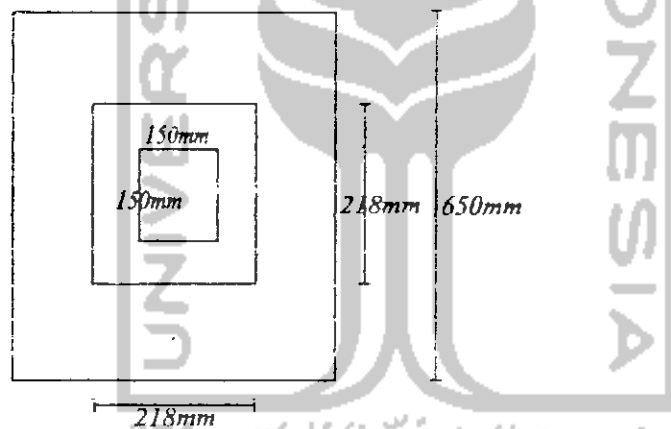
Gaya Geser Pondasi Satu Arah
